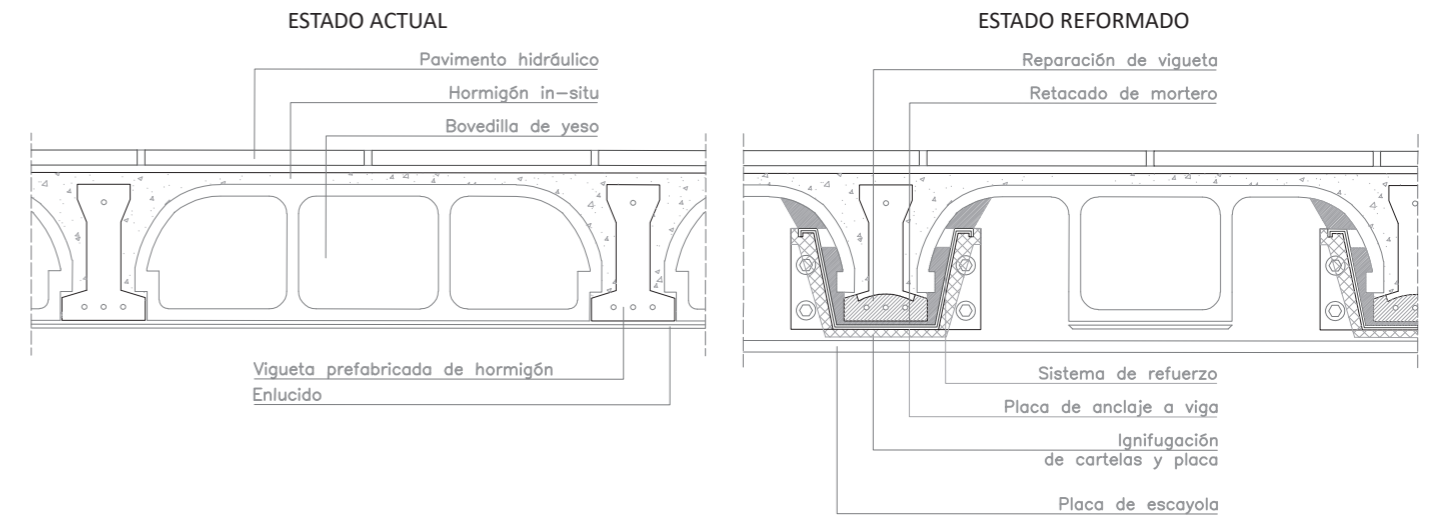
Detalle constructivo. Refuerzo de viguetas bajo cubiertas.
